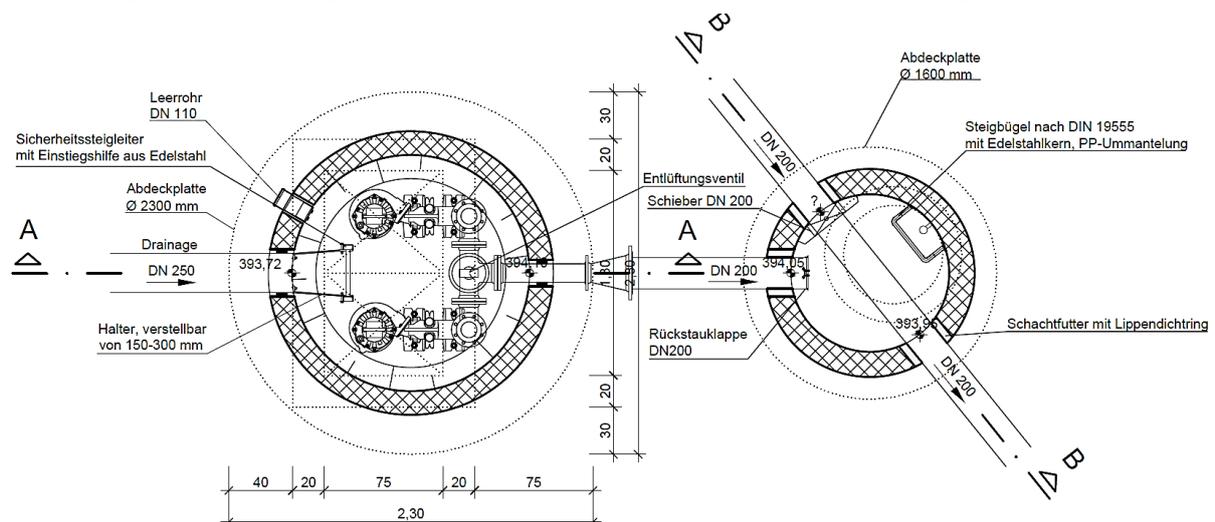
Grundriss Schachtpumpwerk 1 und Schieberschacht
